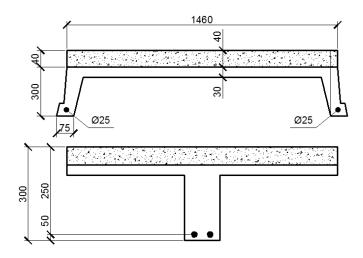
Поперечный разрез усиленной железобетонной плиты и ее приведенное поперечное сечение (к решению задачи 1)
